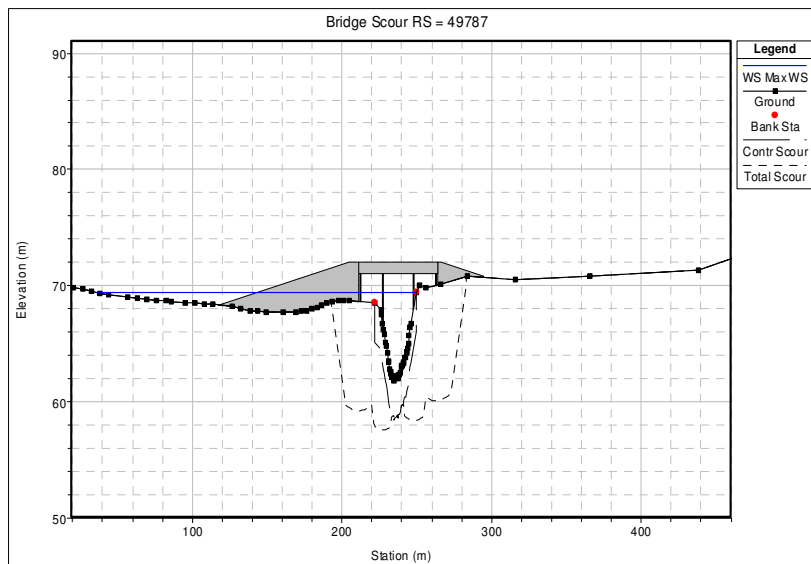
Puente en Piedra Grande - Perfil Transversal erosionado – d50: 0.50mm
